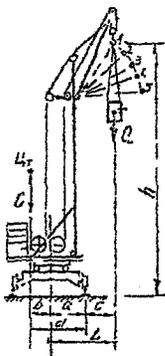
Упрощенная расчетная схема крана при работе с грузом
